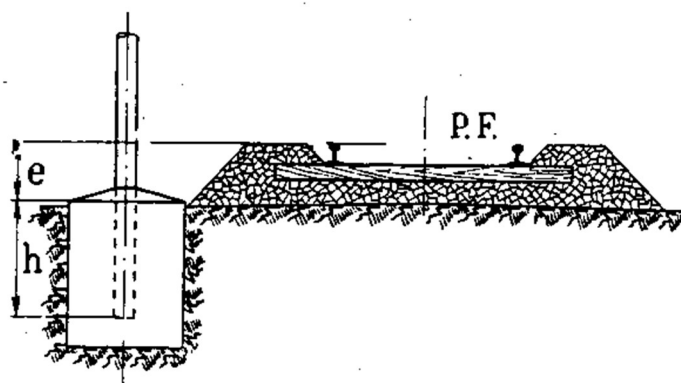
Incastro dei pali nei blocchi di fondazione
